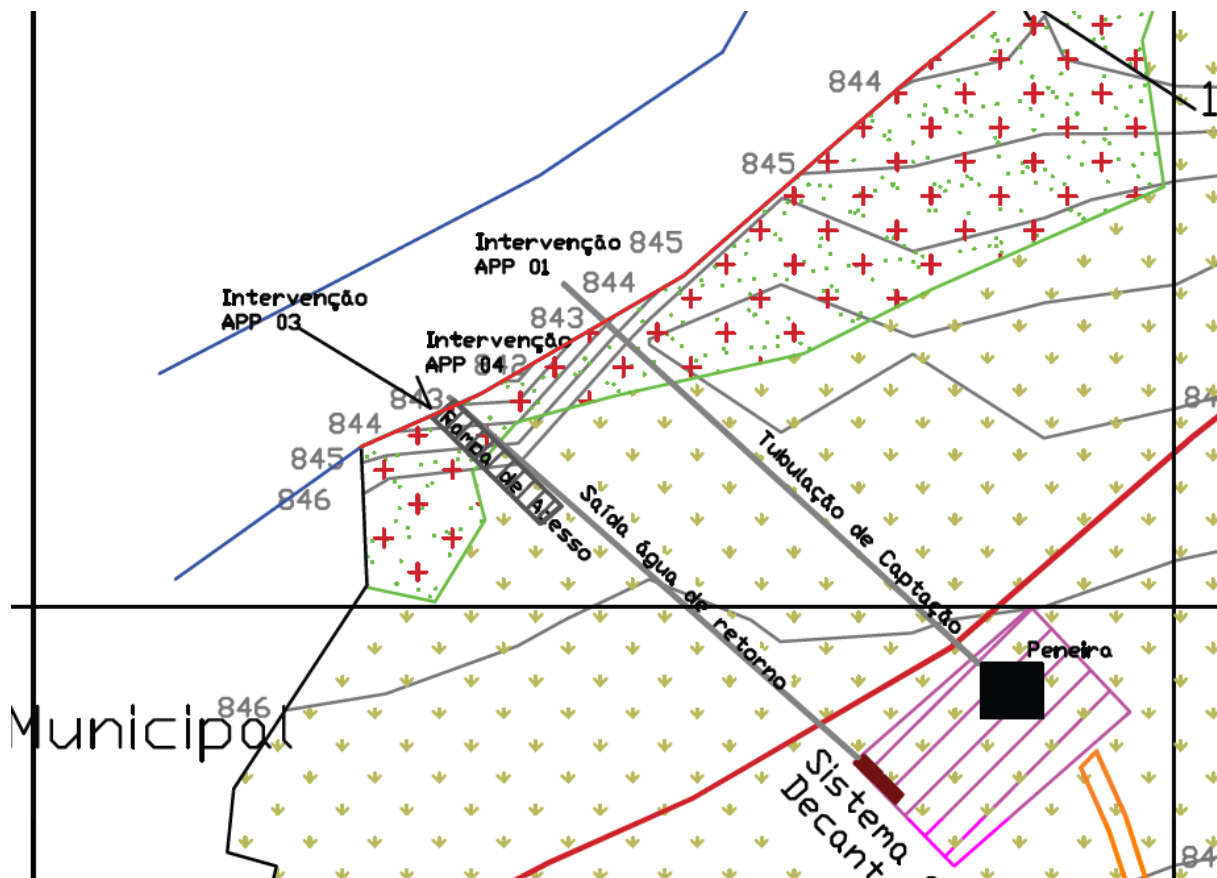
Detalhe das intervenções em APP, com foco na rampa de acesso.
